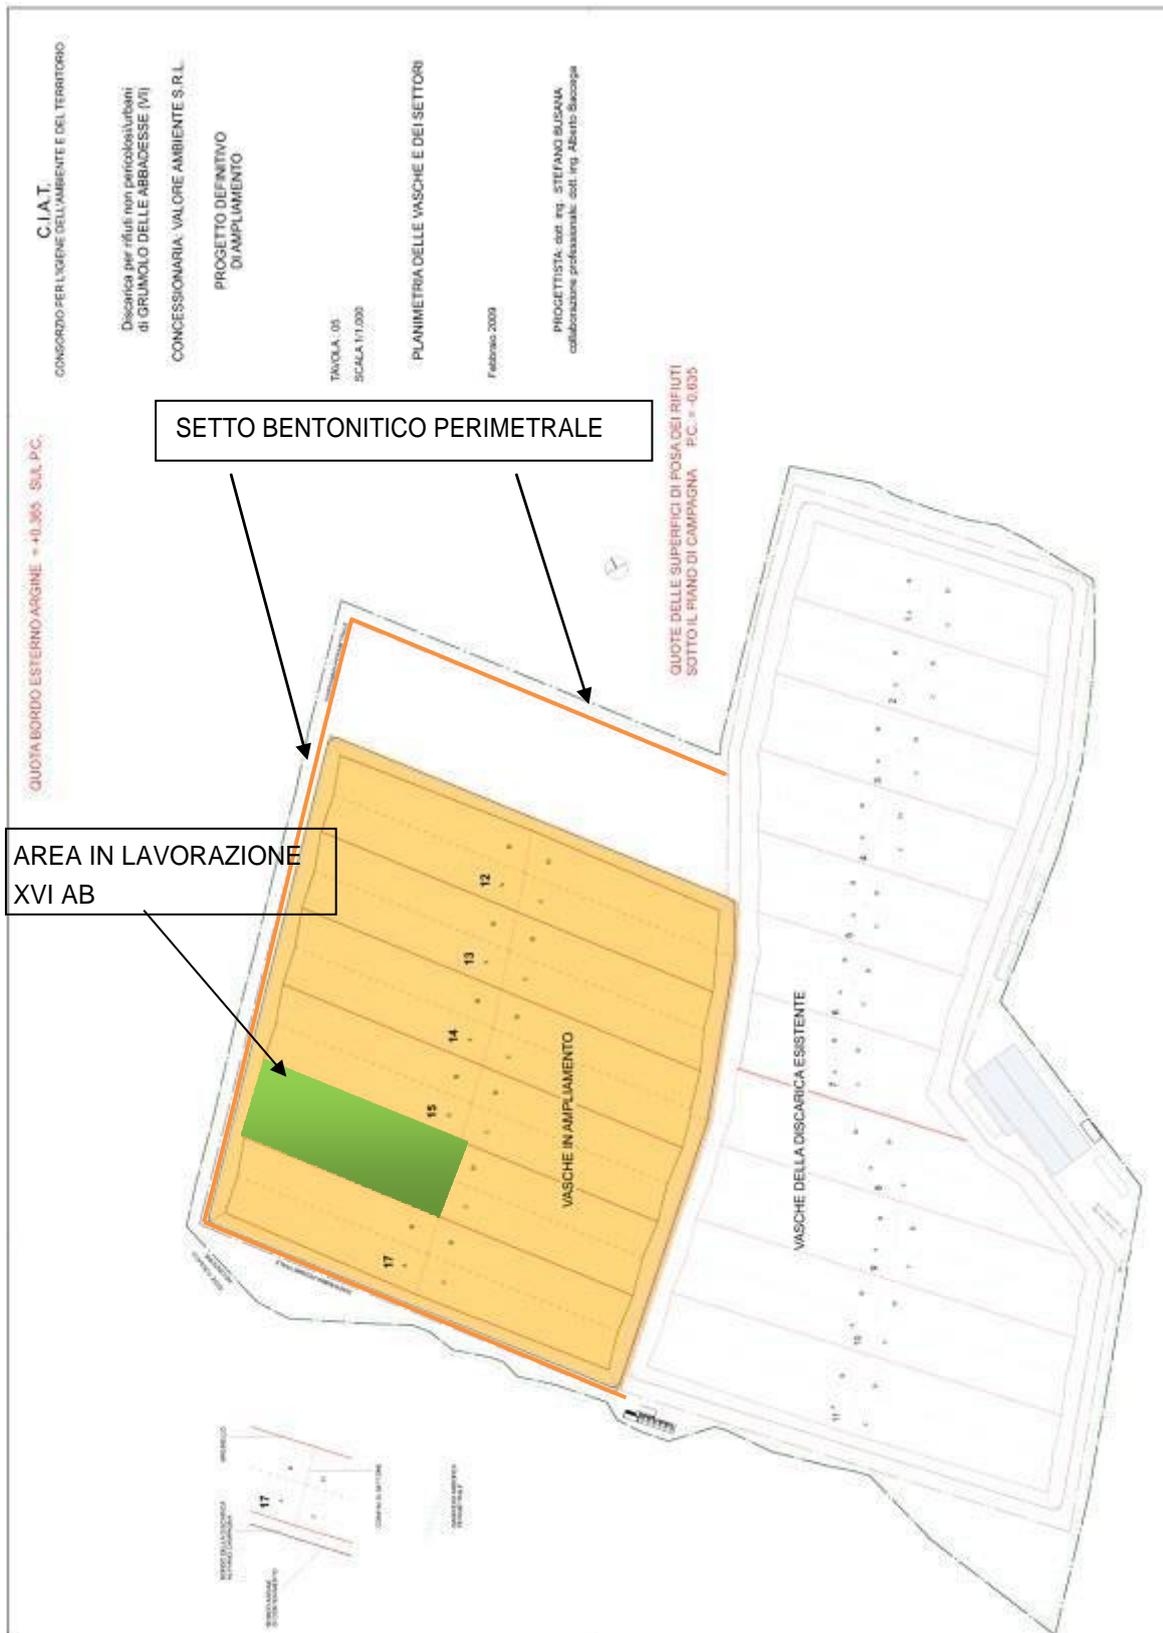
planimetria dello stato di avanzamento lavori di approntamento vasche
